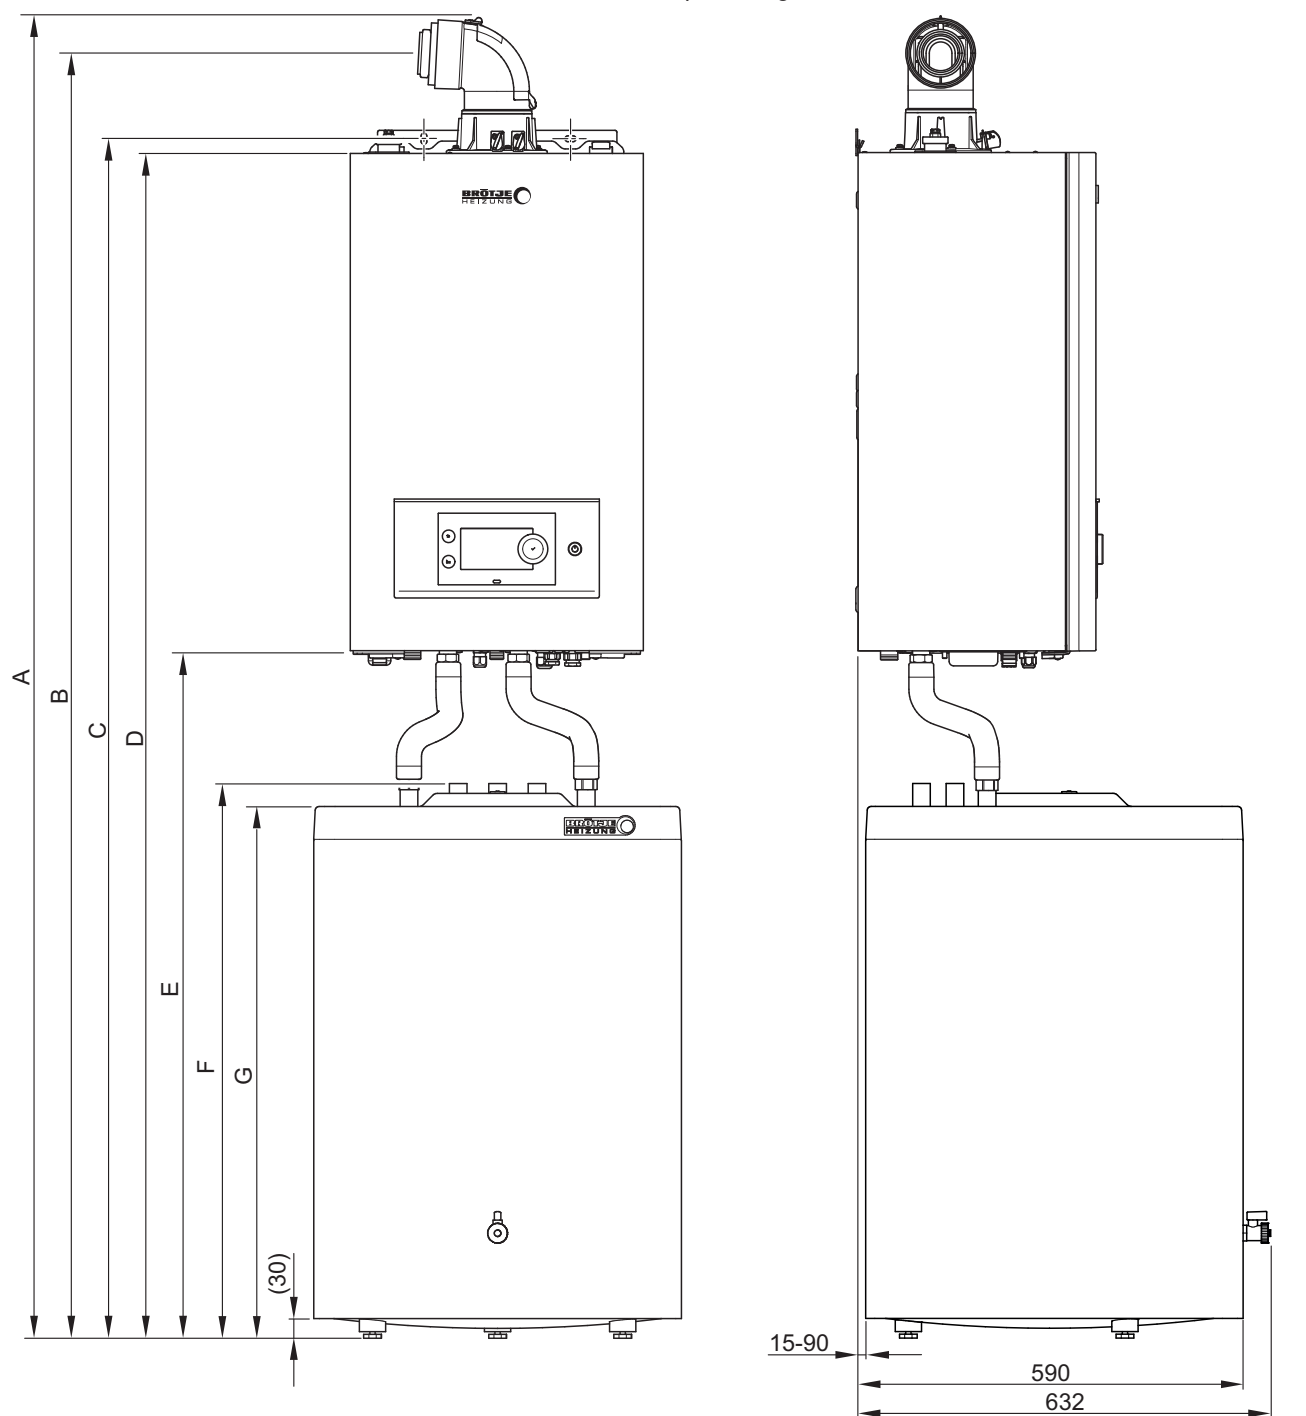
Dimensioner WGB med AEH B/ADH B afspærringsventiler
